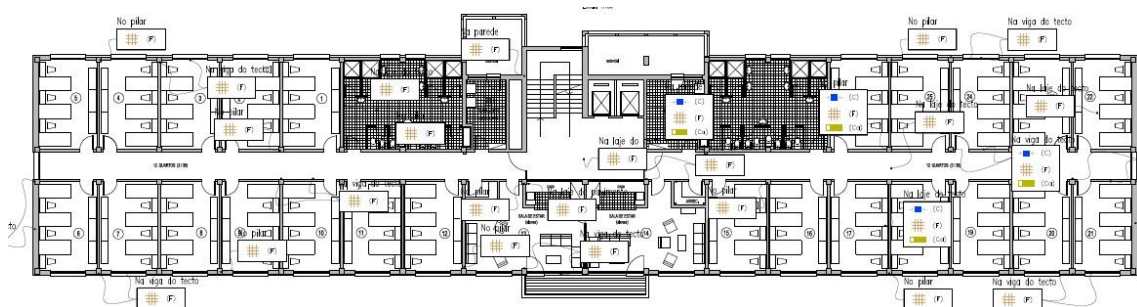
Planta dos pisos 2,3 e 4 (Betar, 2011)
